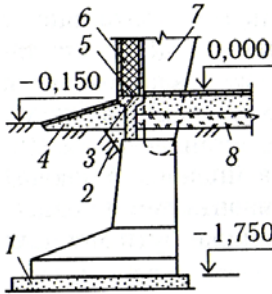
Фундамент під несучі розпірні конструкції:
